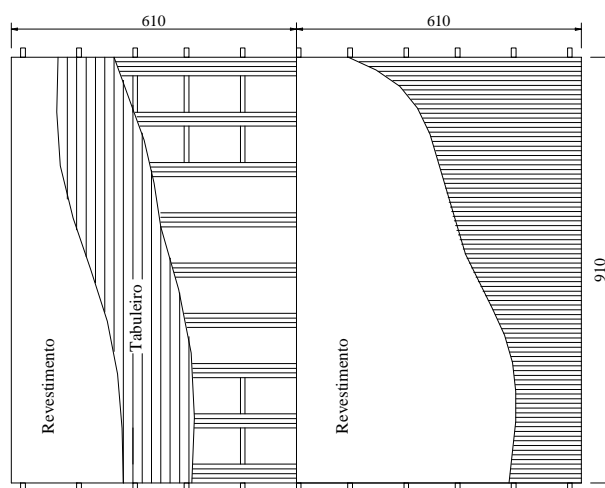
Planta da ponte em Tuscaloosa (TRICHE, 1994).
